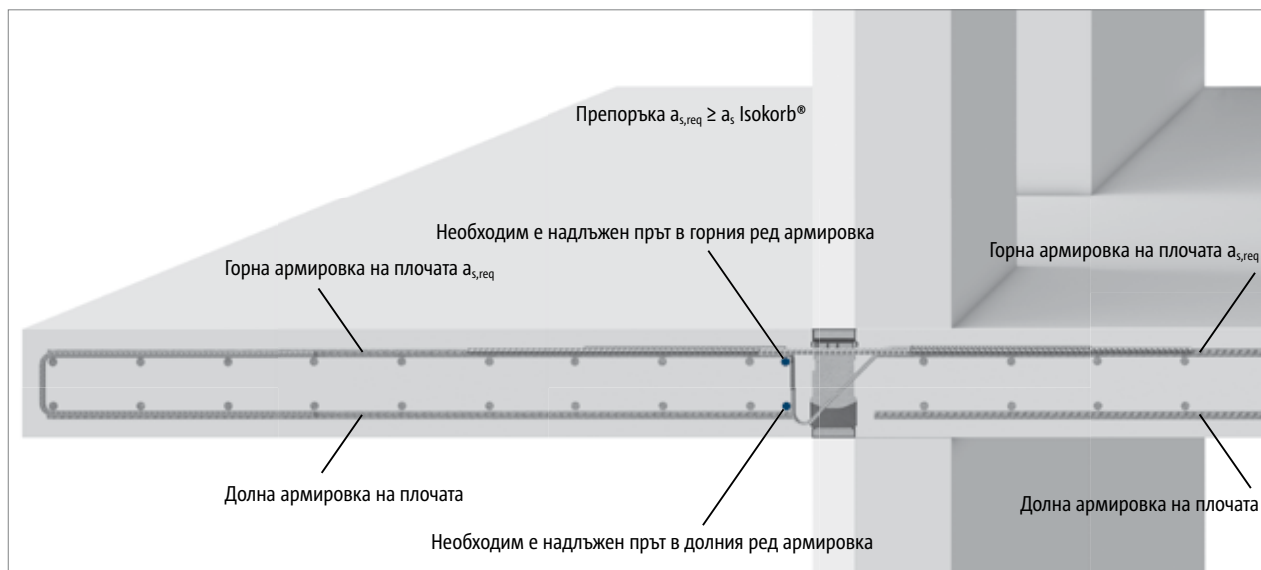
Schöck Isokorb® T тип KL: Дължина на застъпване l_0 , бетонно покритие CV
